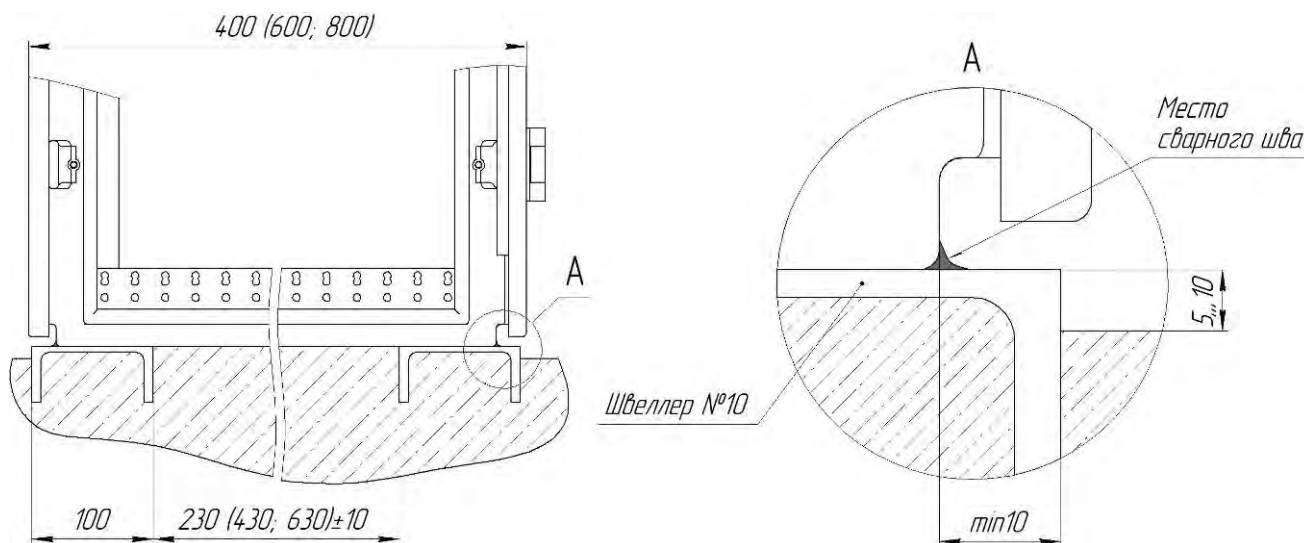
Крепление РТЗО-88МБ к закладным элементам при помощи сварки.
